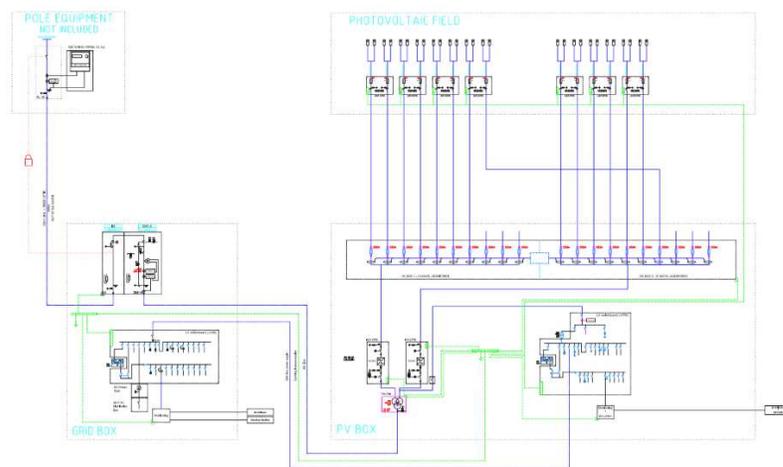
Plano unifilar de la Planta Solar Andacollo
